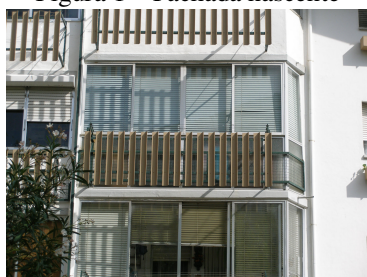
Fachada poente (varanda alterada face ao projecto inicial).
